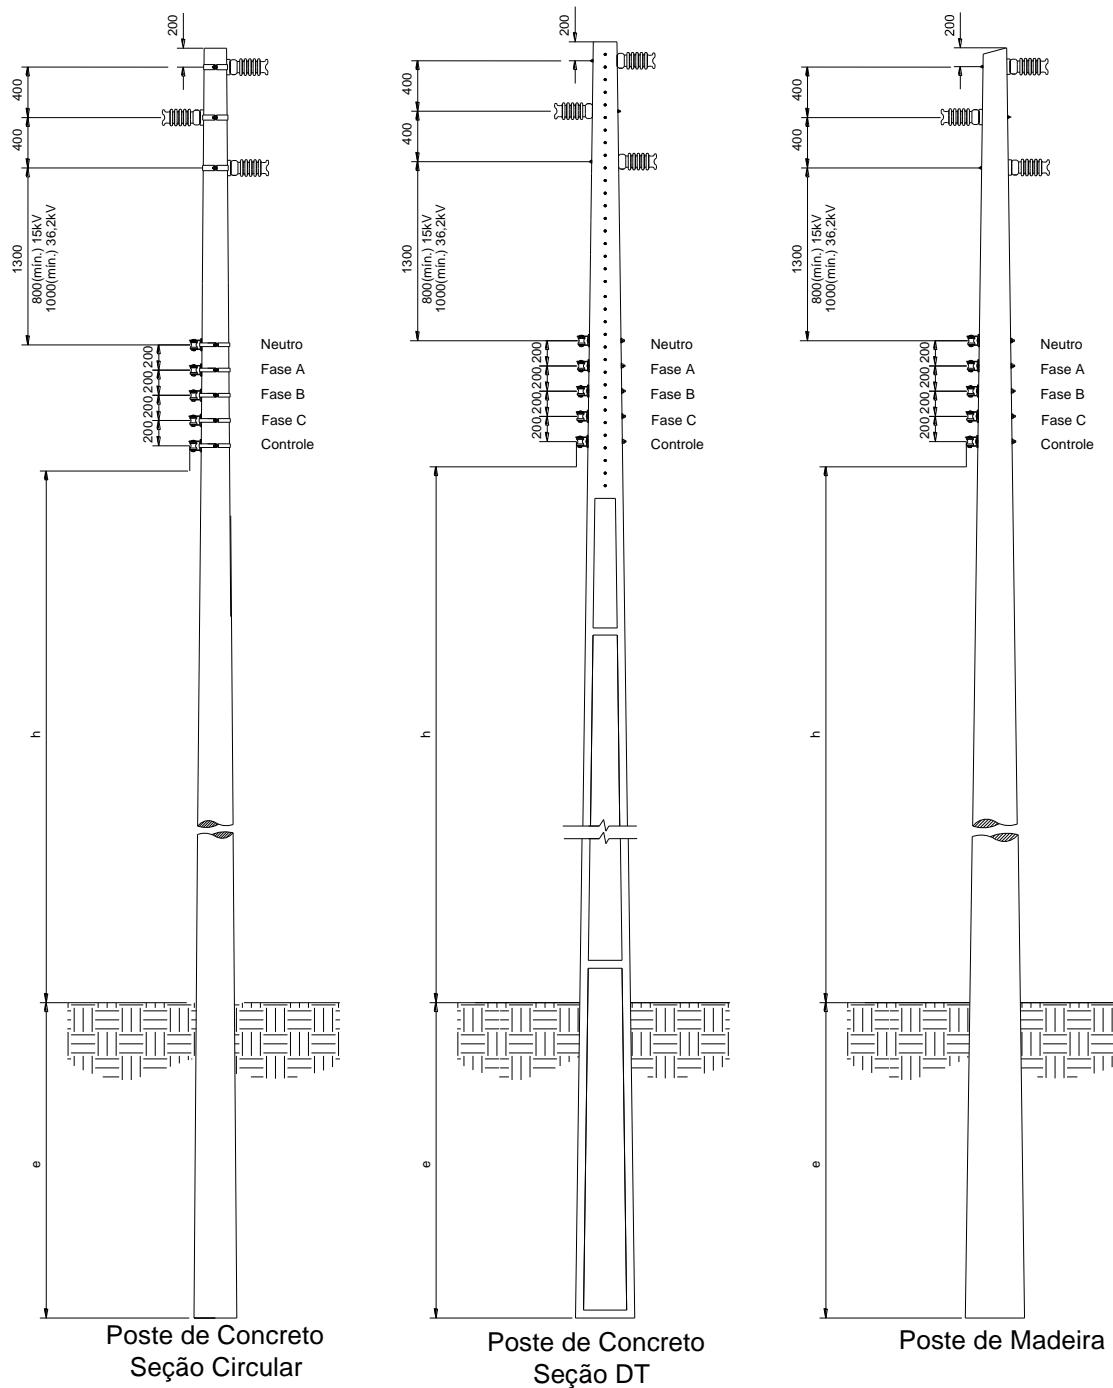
Afastamentos mínimos – Estrutura pilar trifásica tangente
